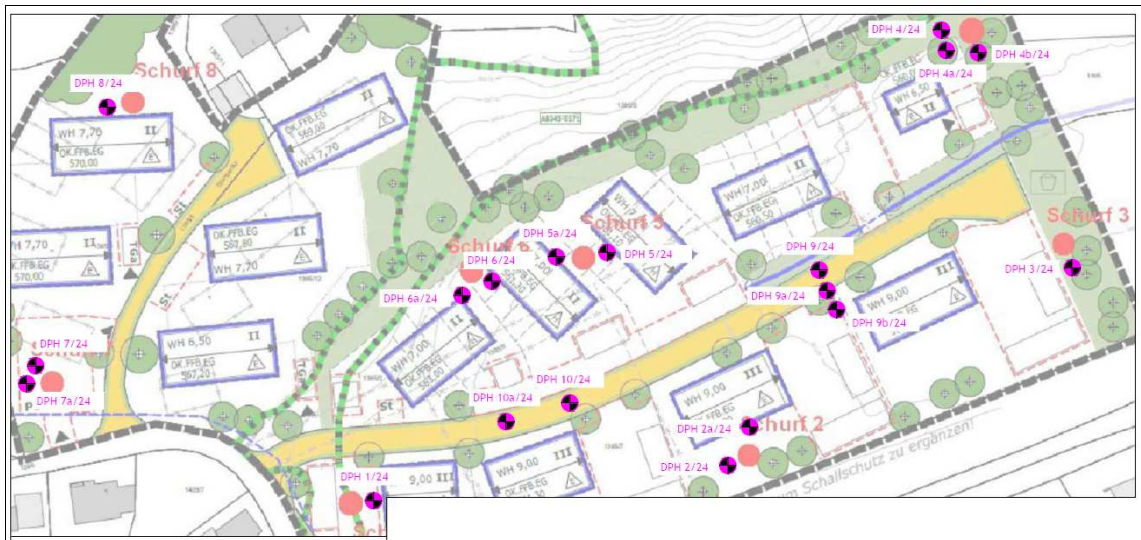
Lageplan der Rammsondierungen (DPH)
